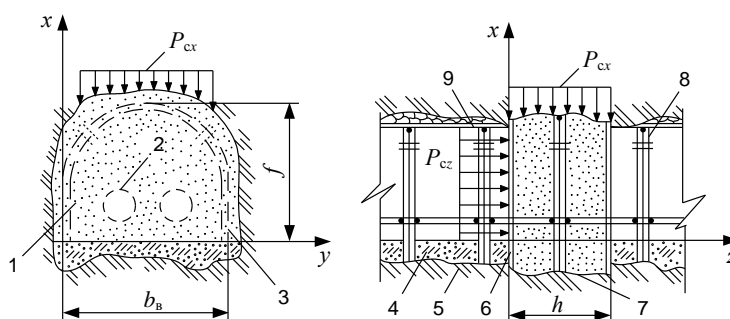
Расчетная схема взрывоустойчивой перемычки:
